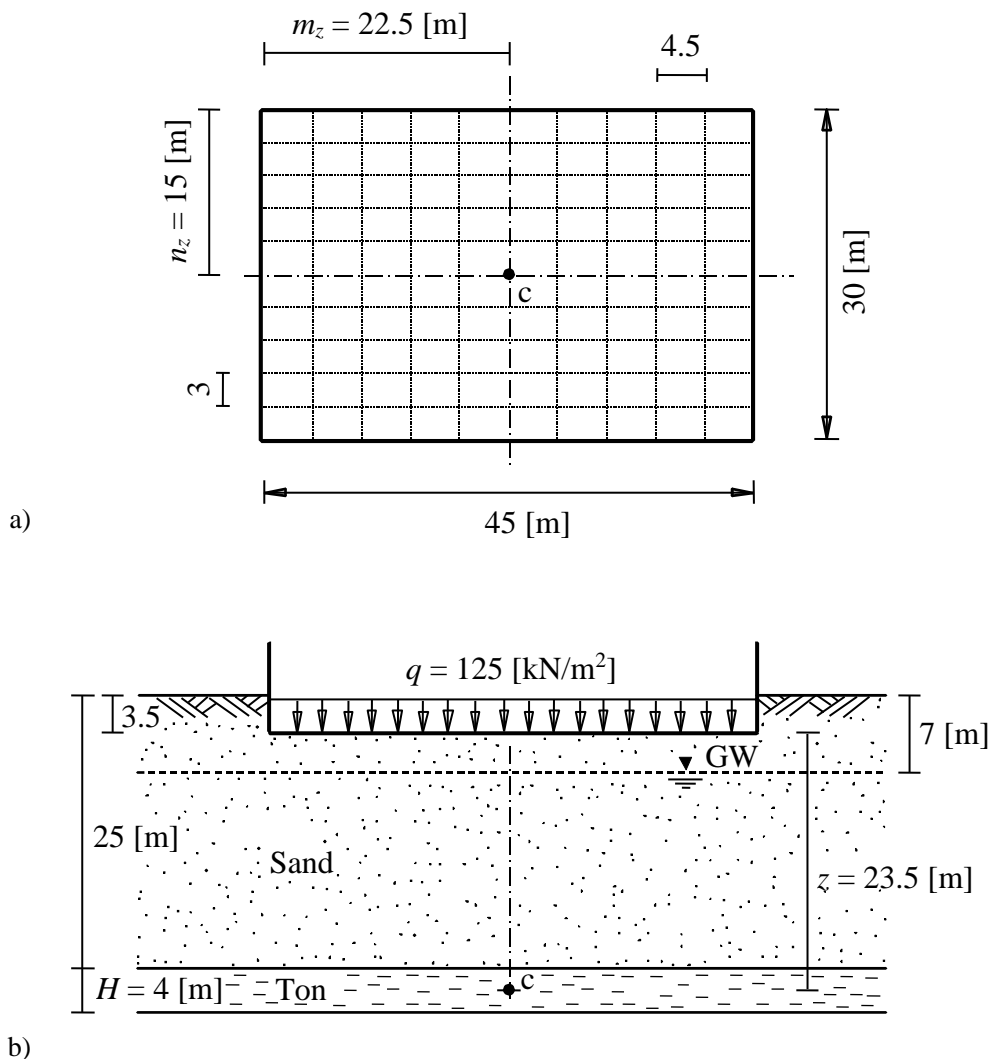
a) Grundriss der Platte mit Abmessungen und FE-Netz
